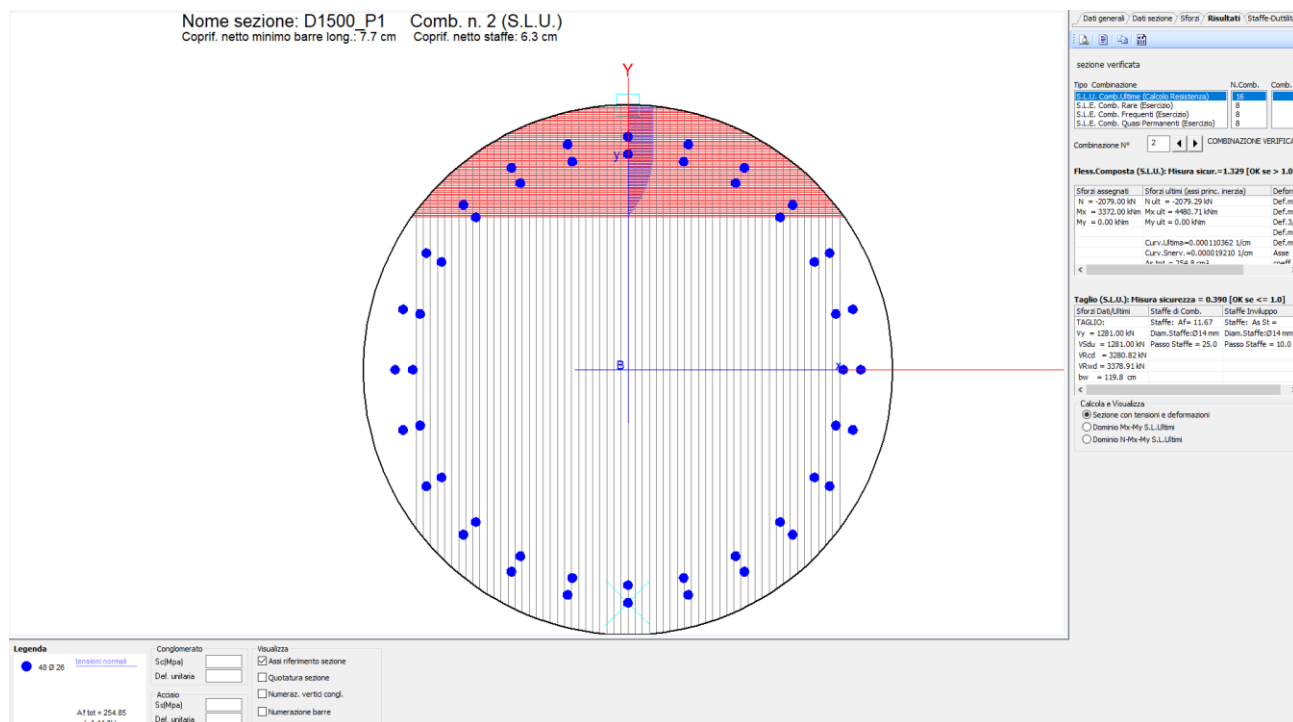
Verifica strutturale palo D1500mm – Pila 1-14
